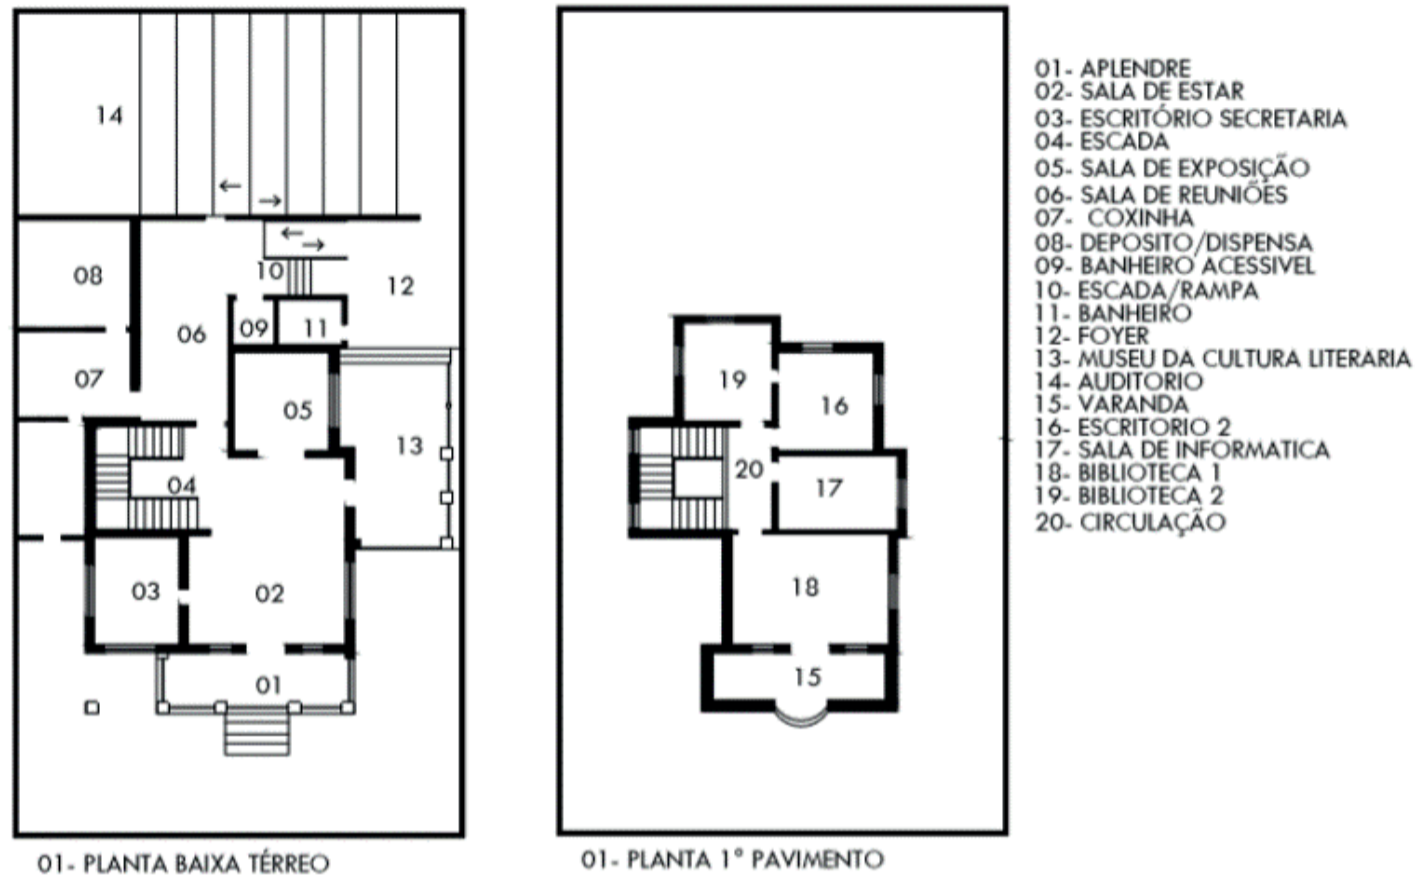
Planta baixa atual da edificação. Fonte: (Autoras, 2018)
